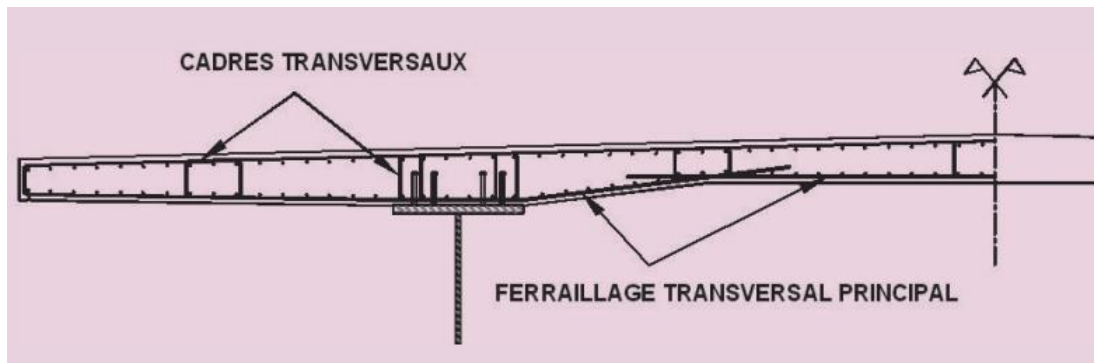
Principe de ferrailage courant de la dalle sans pièces de pont.
